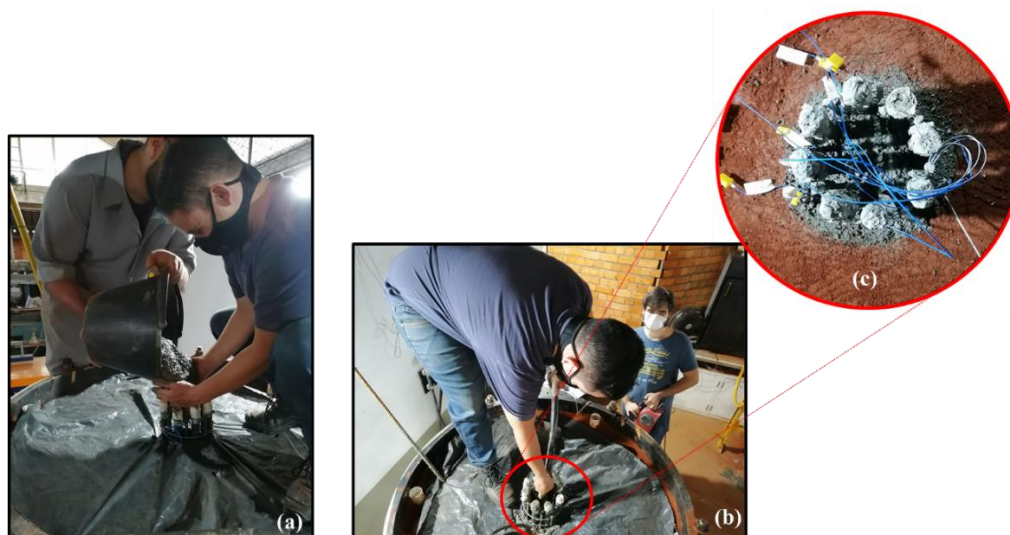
(a) processo de concretagem do protótipo de estaca. (b) Vibração do concreto e (c) detalhamento do protótipo concretado e instrumentado.
